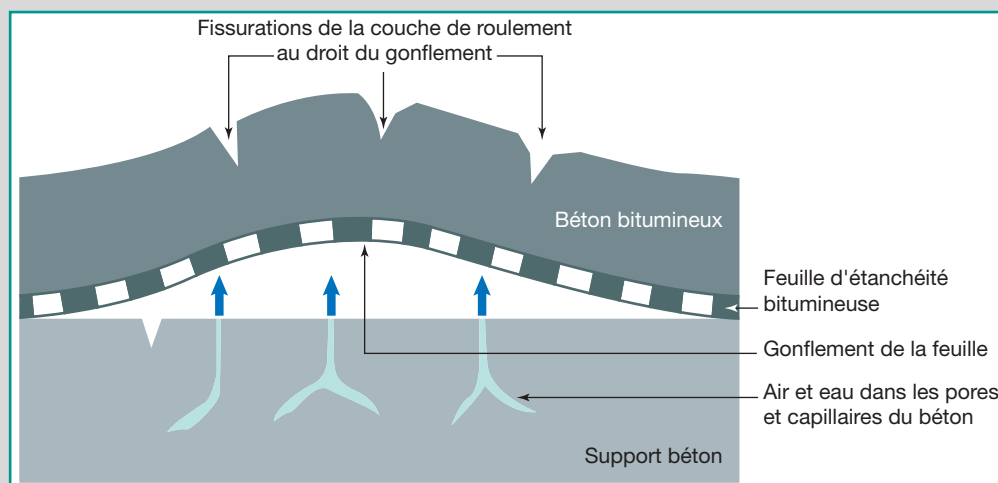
Gonflement d'un complexe étanchéité en feuille et couche de roulement par la pression d'air et d'eau venant du support béton.
